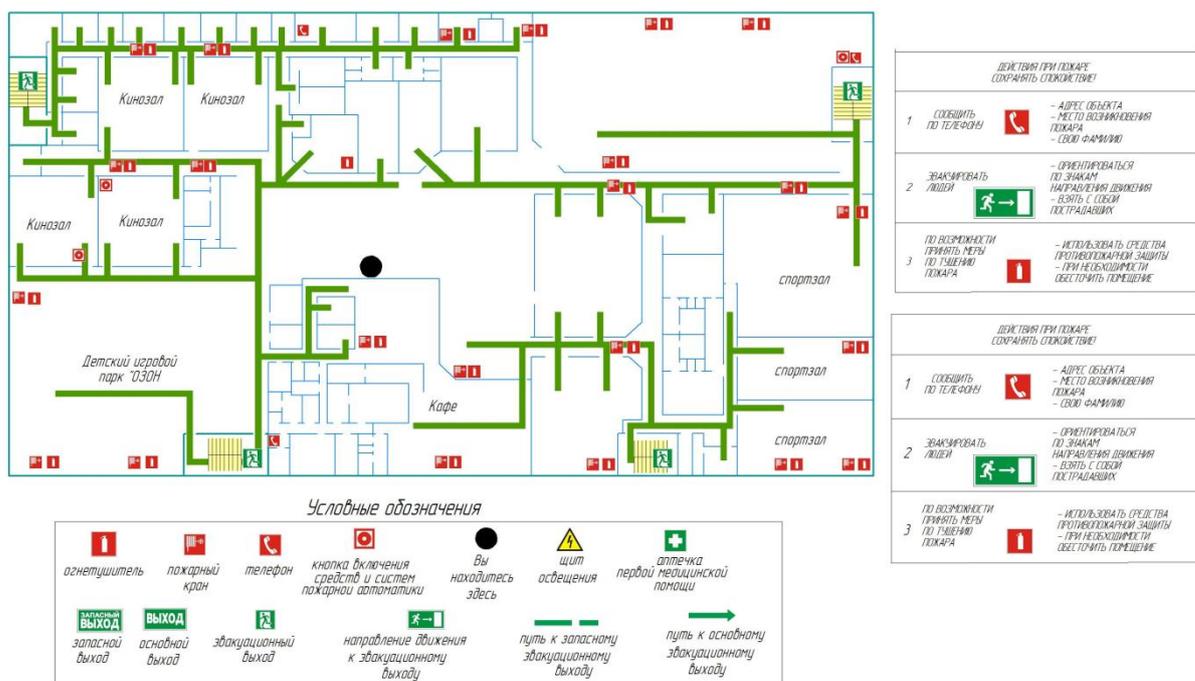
План эвакуации из помещений 2 этажа ТРЦ
